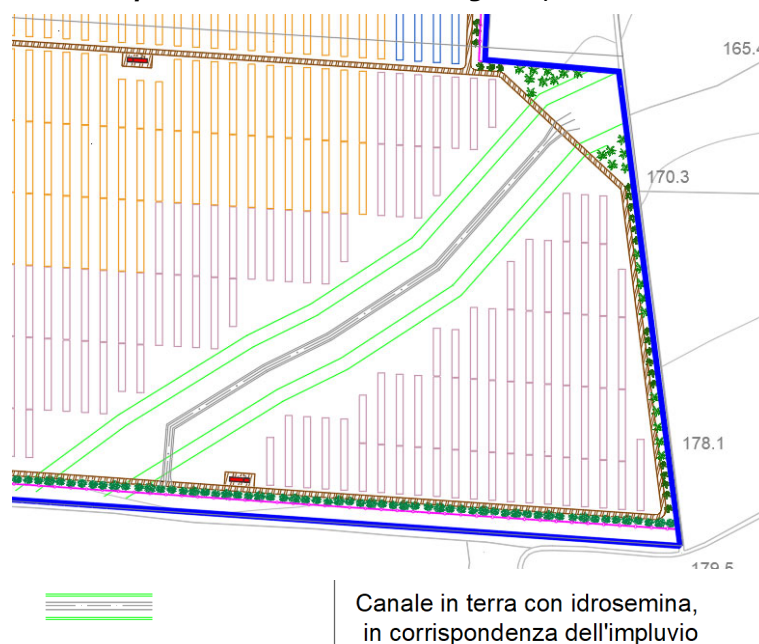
Vista planimetrica della porzione sud-est dell'area d'impianto con indicazione del canale in terra, con idrosemina sulle scarpate, in corrispondenza dell'impiuvio
